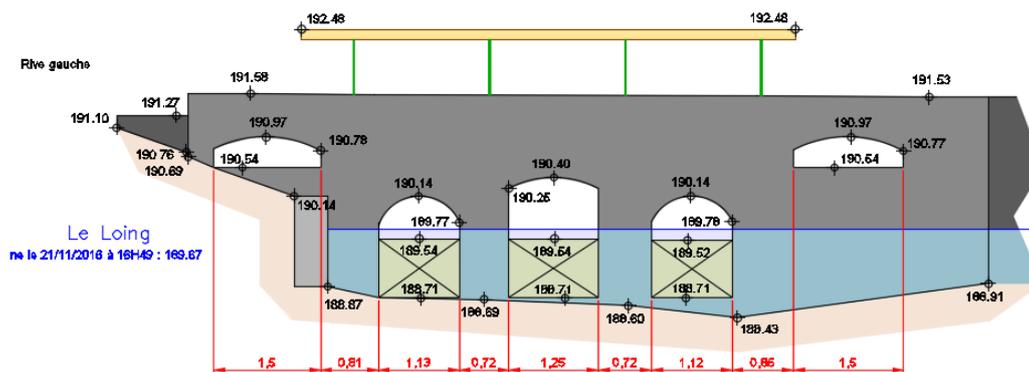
Coupe de l'ouvrage (passe de gauche)
